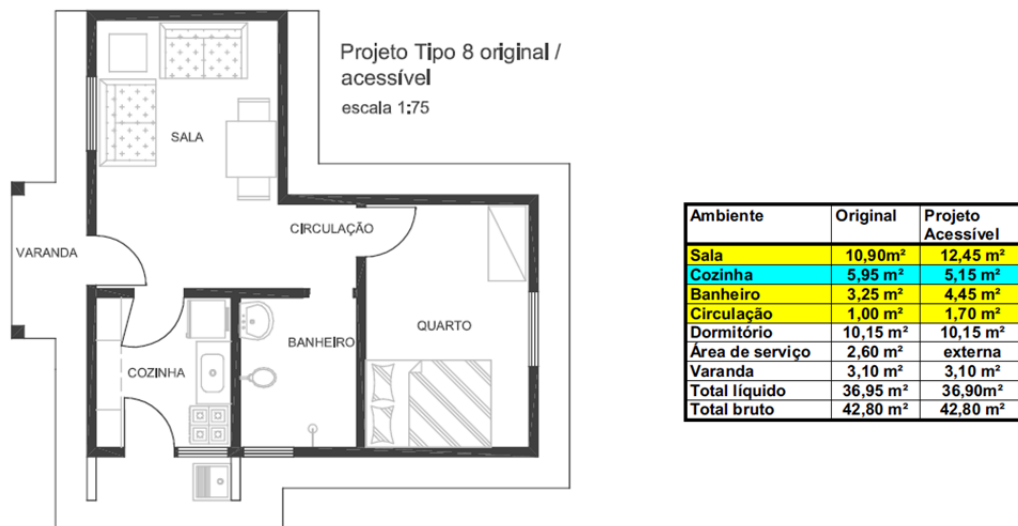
Planta baixa 8A com indicação da demarcação de projeto modificado.
